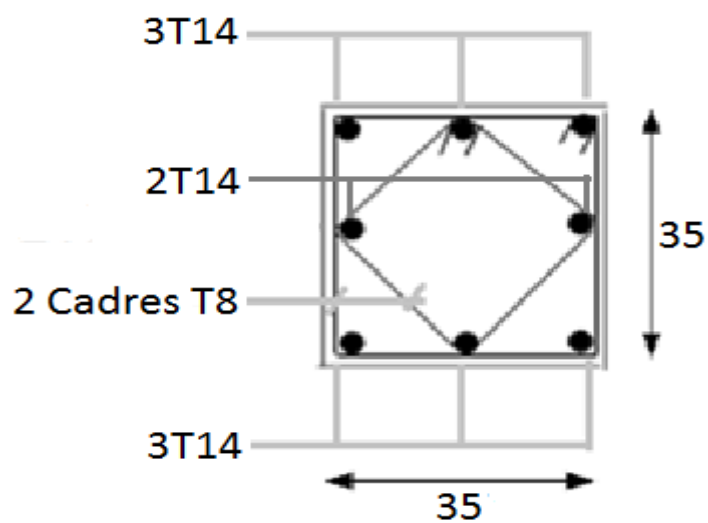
Ferrailage des poteaux de 5^{ème} étage.
